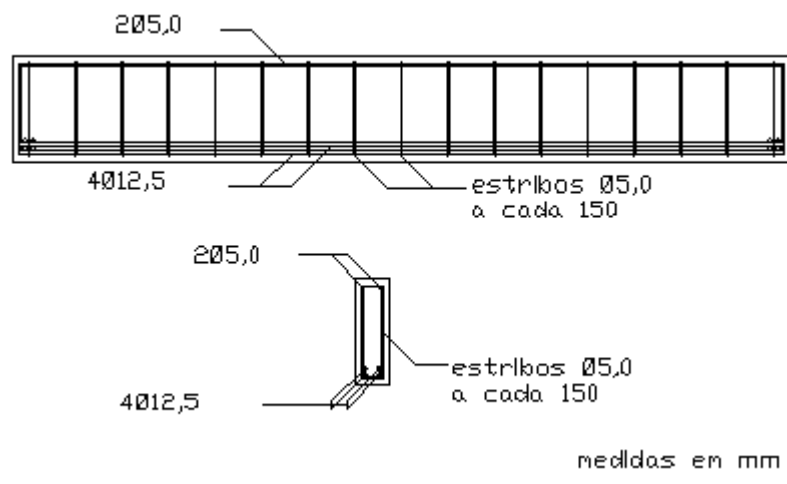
Detalhe da armadura das vigas VM2 e VPF5
